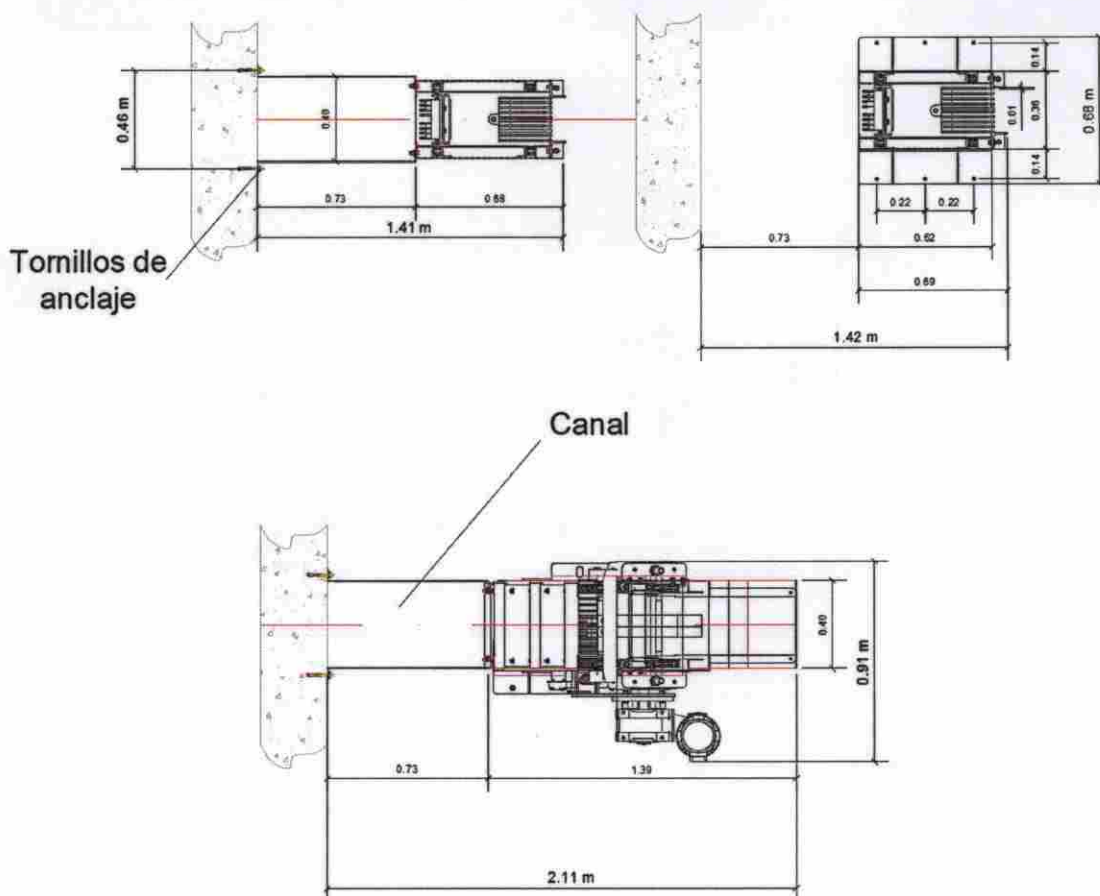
Vistas en planta del canal y de la reja, en la zona de entrada de aguas, en la zona central y en la superior, respectivamente. Fuente: Elaboración propia
